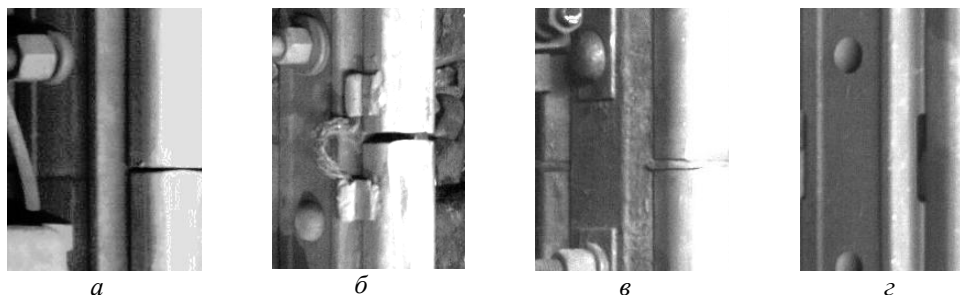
Типы рельсовых стыков: а – обычный стык без соединителя; б – обычный стык с соединителем; в – изолирующий стык; г – сварной стык
